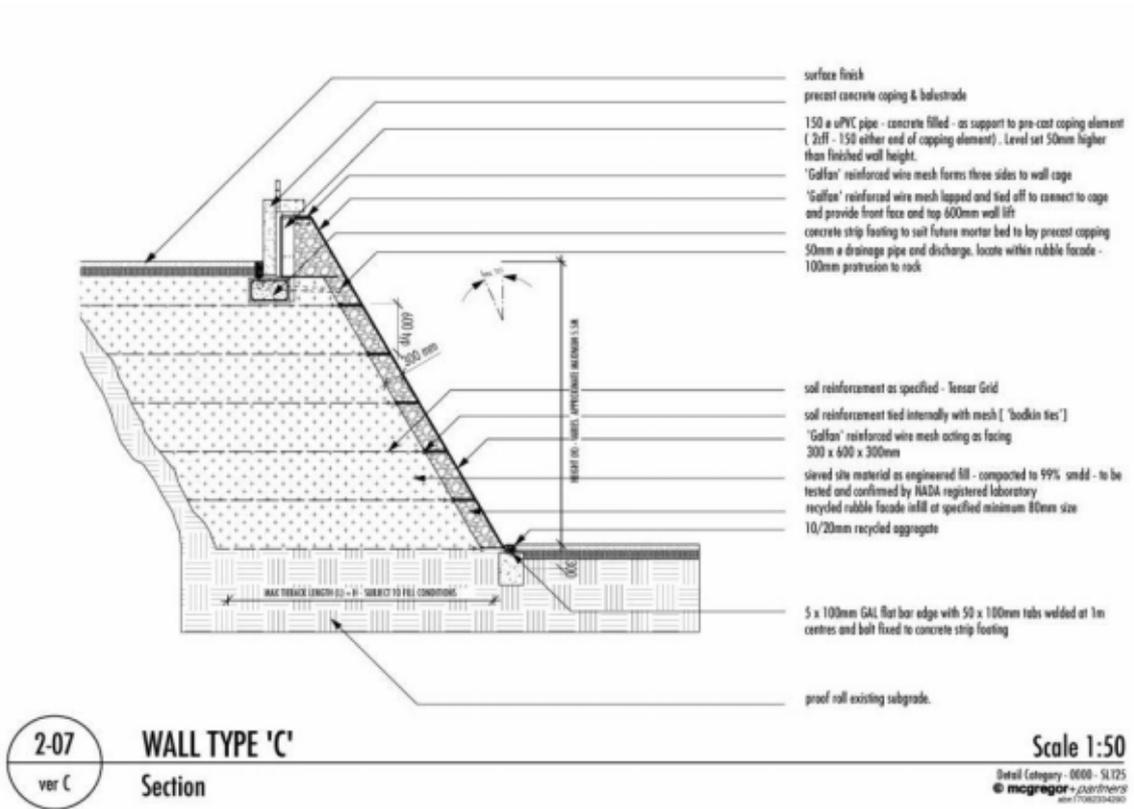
11-12: Sezione e foto dei nuovi muri di contenimento
